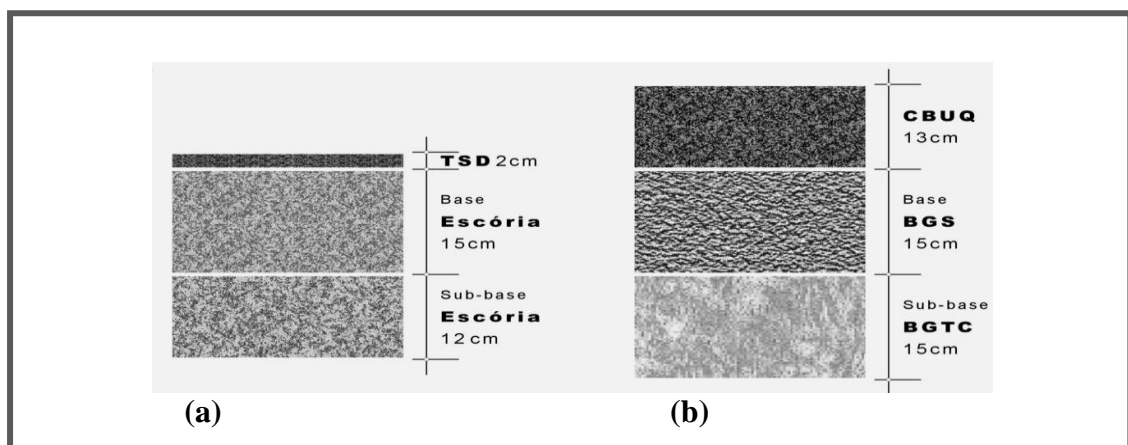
(a) e (b) - Estrutura dos pavimentos analisados - (a) estrutura do pavimento do acesso a Ipaba MG - (b) estrutura do pavimento da BR-381 - lote 15 (ROHDE, 2002).
